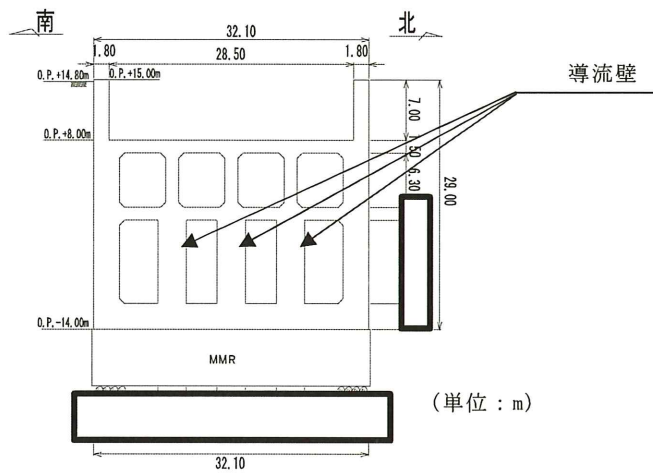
第 3 号機海水ポンプ室断面図 (A-A 断面, 南北 (スクリーンエリア))
